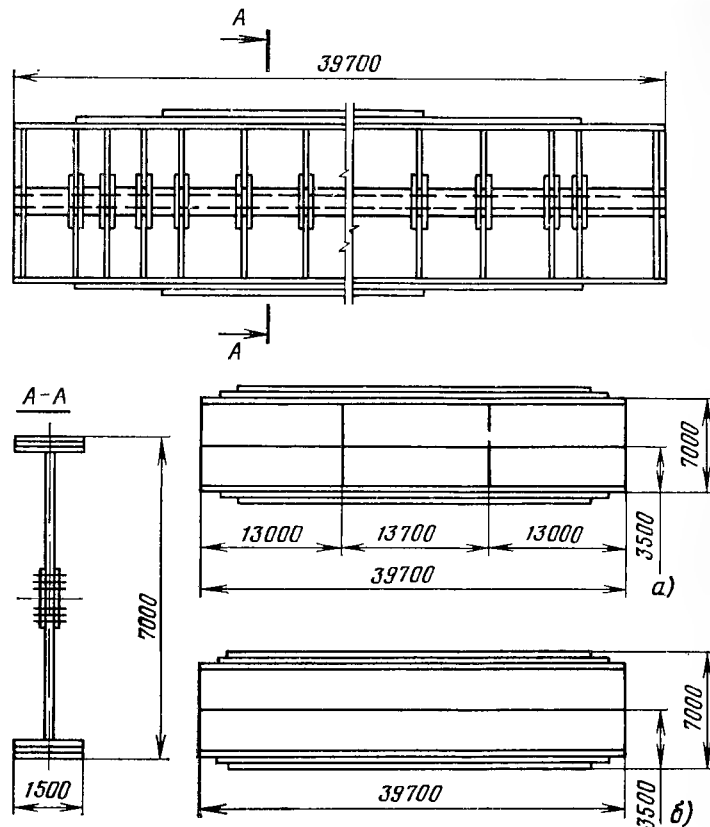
Хребтовая балка каркаса котельного отделения.
